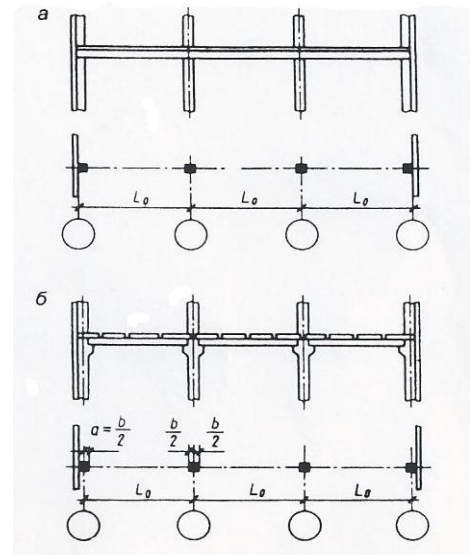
Модульные координационные оси колонн (разрез и план): 1-балка или ригель перекрывают колонну, б-балка, ферма, ригель опираются на консоль колонны
